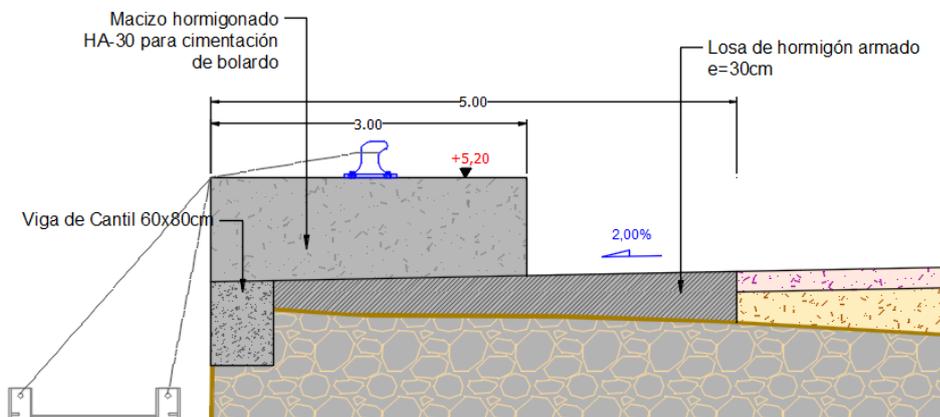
Sección Tipo de piezas de cimentación de bolardos
